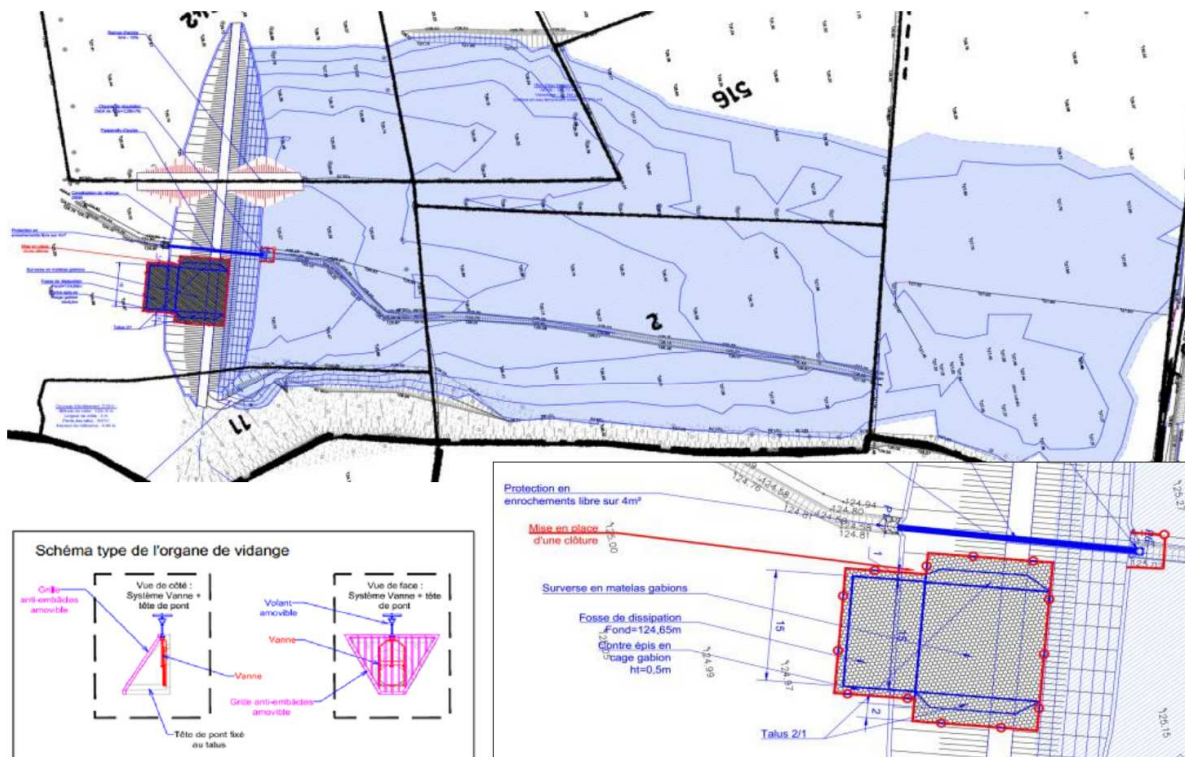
Extrait du plan de masse – Ouvrage D15-3
